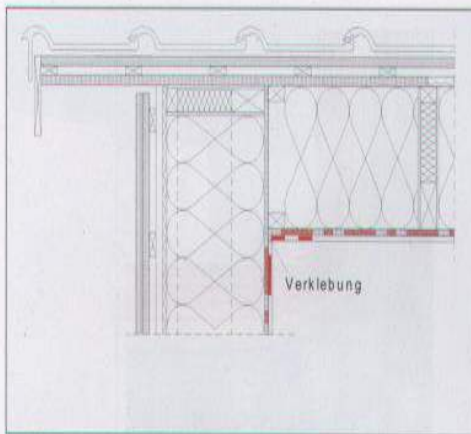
Anschlussdetail Ortgang, Holz-Leichtbau Wand und Dach [63]
